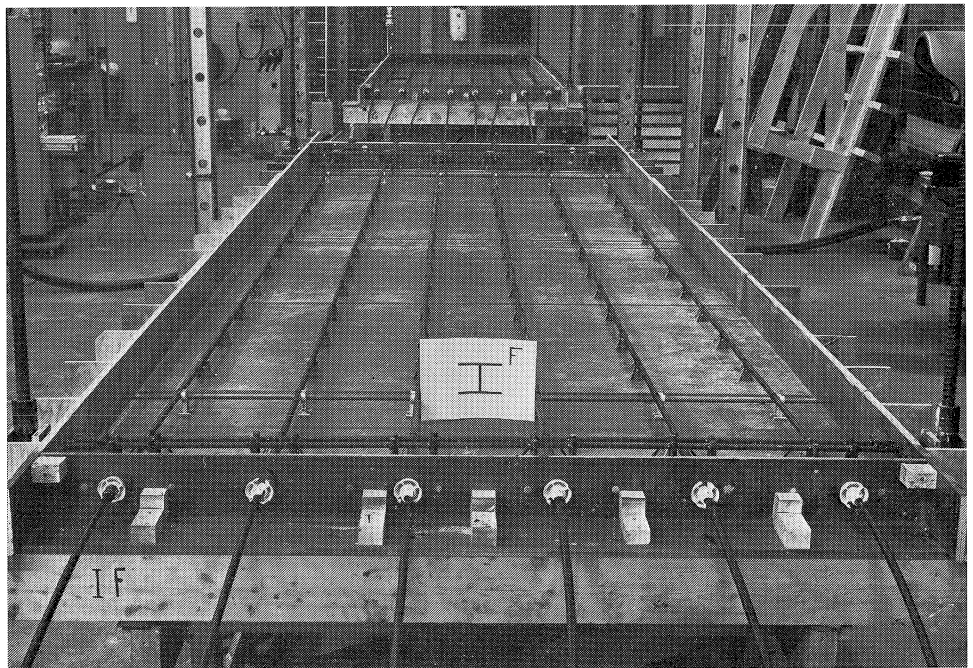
Schalung und Bewehrung einer Platte ohne Betonstahlmatten.
